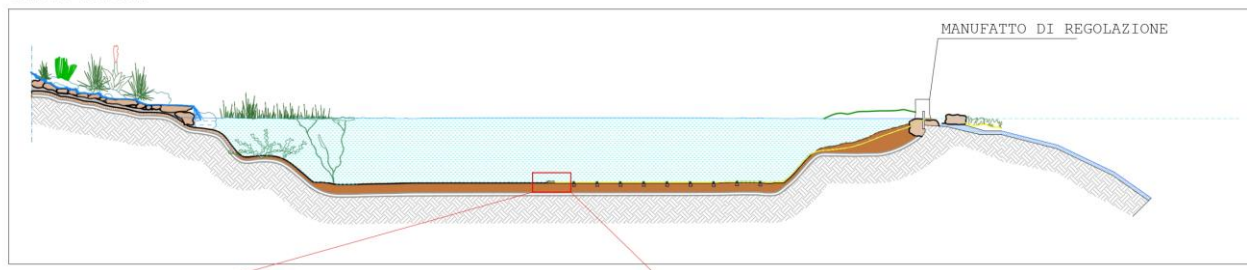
Sezione tipologica: posa di tubazioni sul fondo del lago, con scarico attraverso la briglia esistente opportunamente modificata, con funzionamento a sifone
